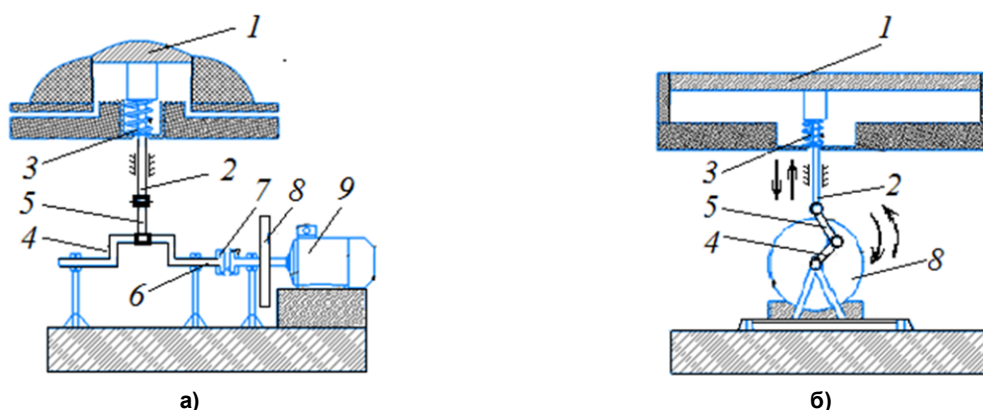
Дорожная энергетическая установка: а – конструктивная схема вид спереди; б – конструктивная схема вид сбоку
